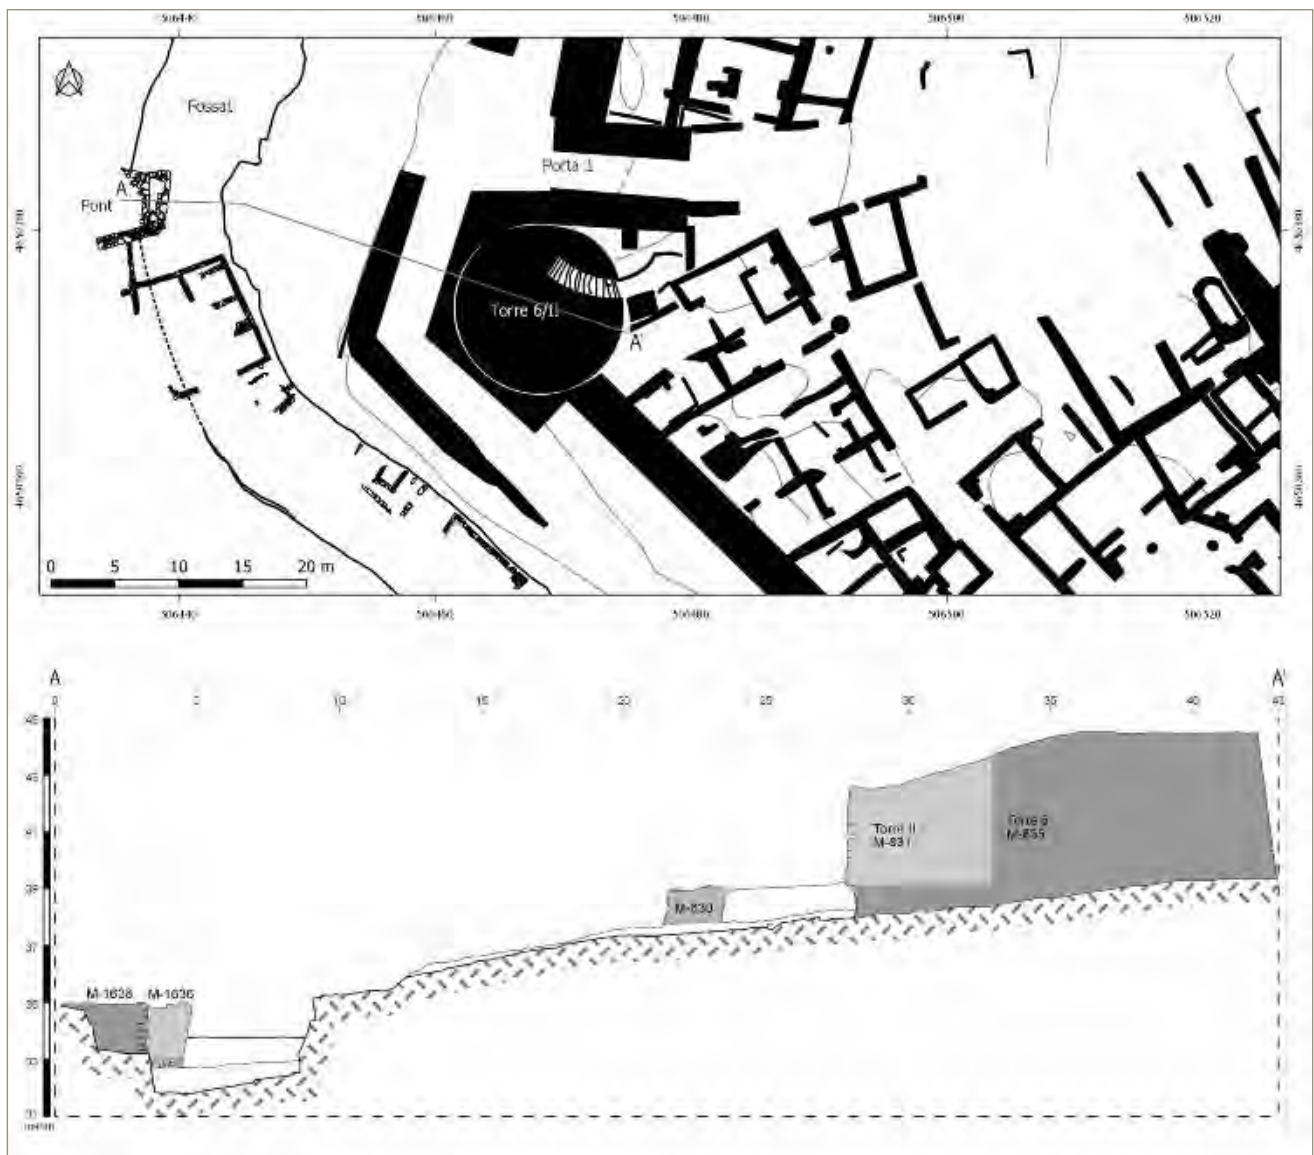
Planta de detall de les estructures construïdes dins del fossat i planta/secció del pont.
